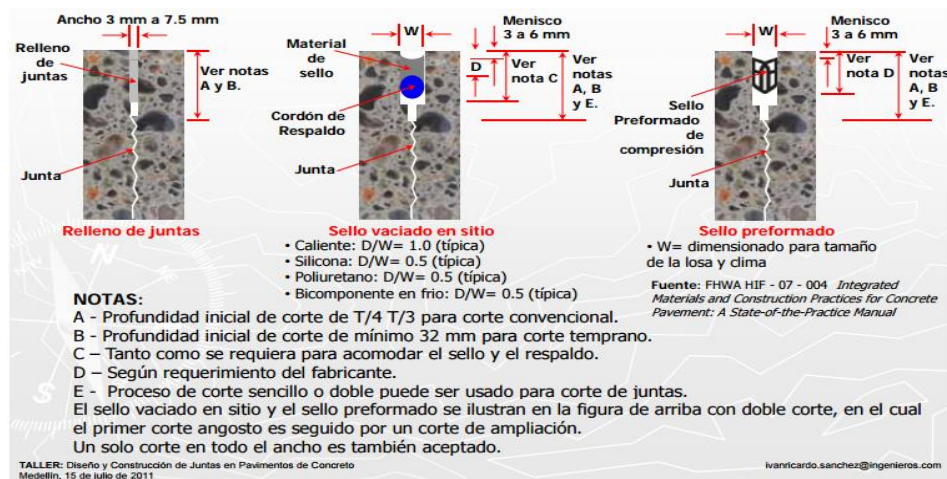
Detalle juntas. Fuente: Ivan Ricardo Sanchez. Taller diseño y construcción de juntas en pavimentos de concreto. 2011.
